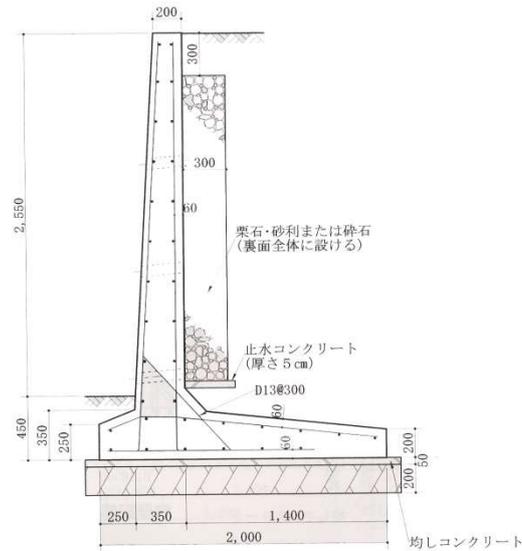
2 標準構造図 (鉄筋コンクリート倒立 T 型擁壁、高さ 3m の場合)
